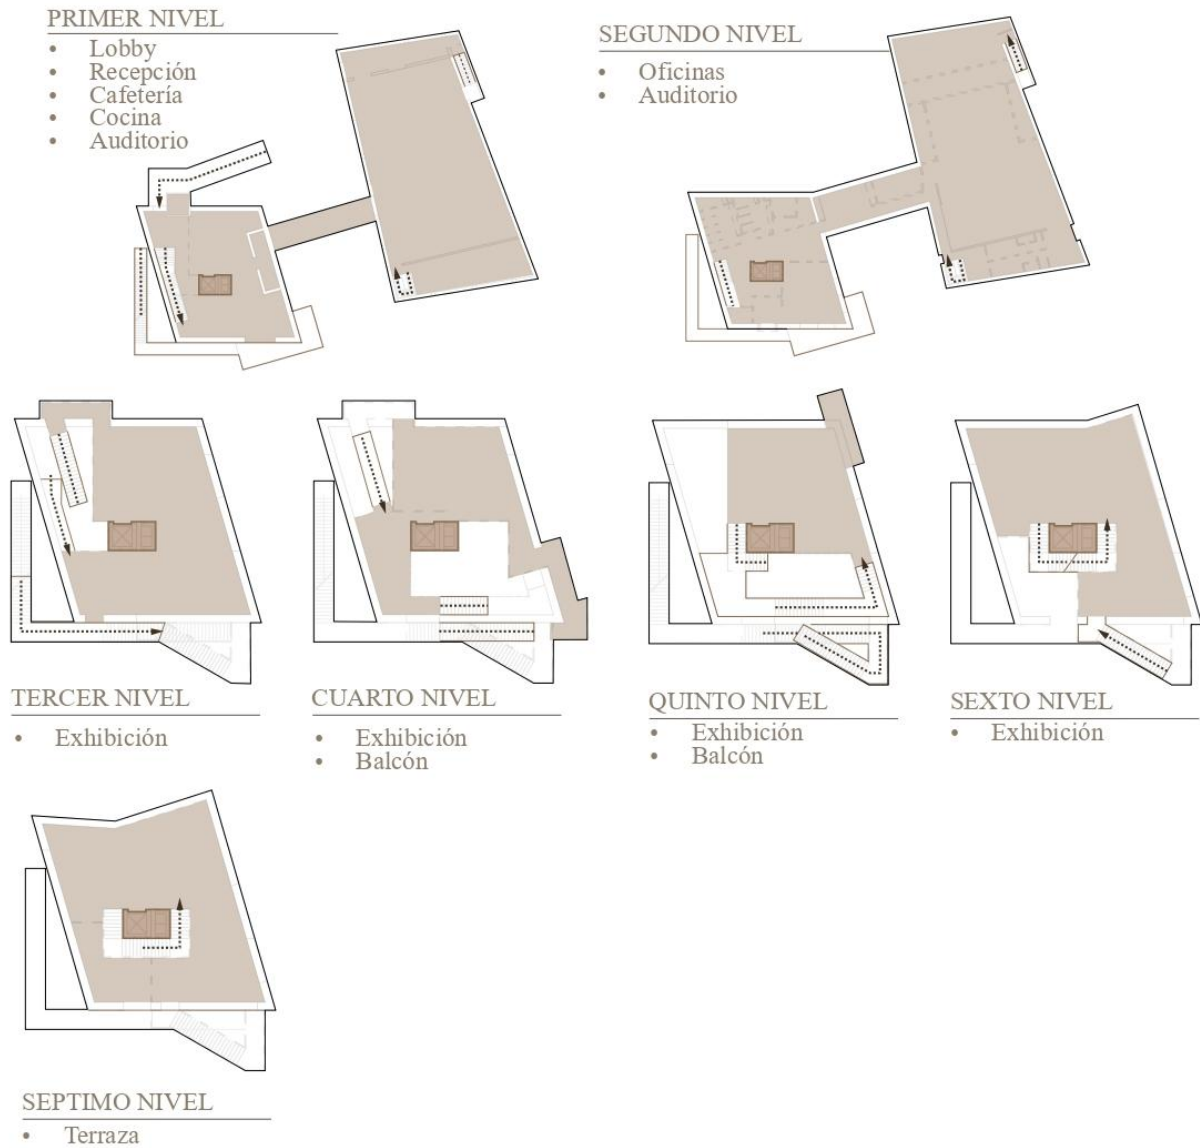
Análisis de planimetría a través de polilíneas Knut Hamsun Center (Autoría Propia 2025)
